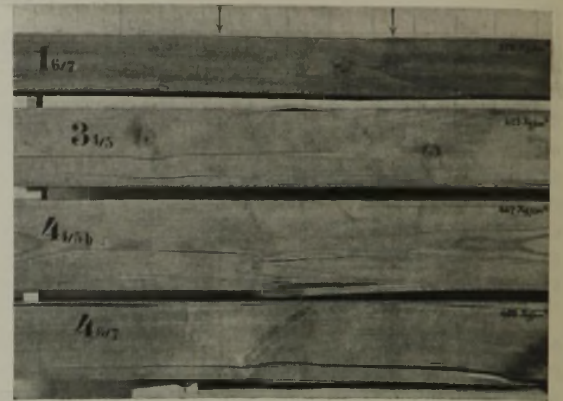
Bemerkenswerte Bruchbilder nach Biegeversuchen mit „nassem“ Holz.
